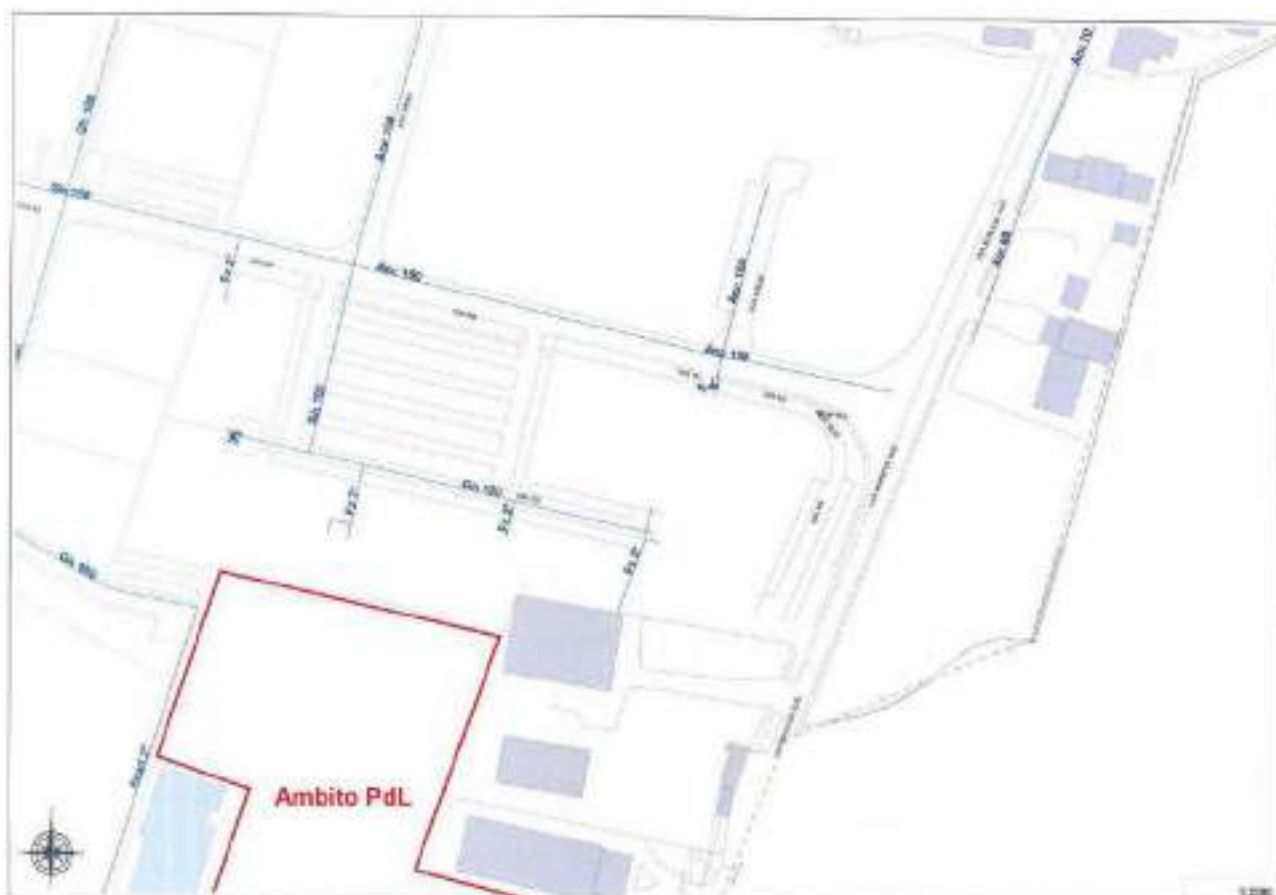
/2: Planimetria rete acquedotto esistente e ambito oggetto di PdL (in rosso)
